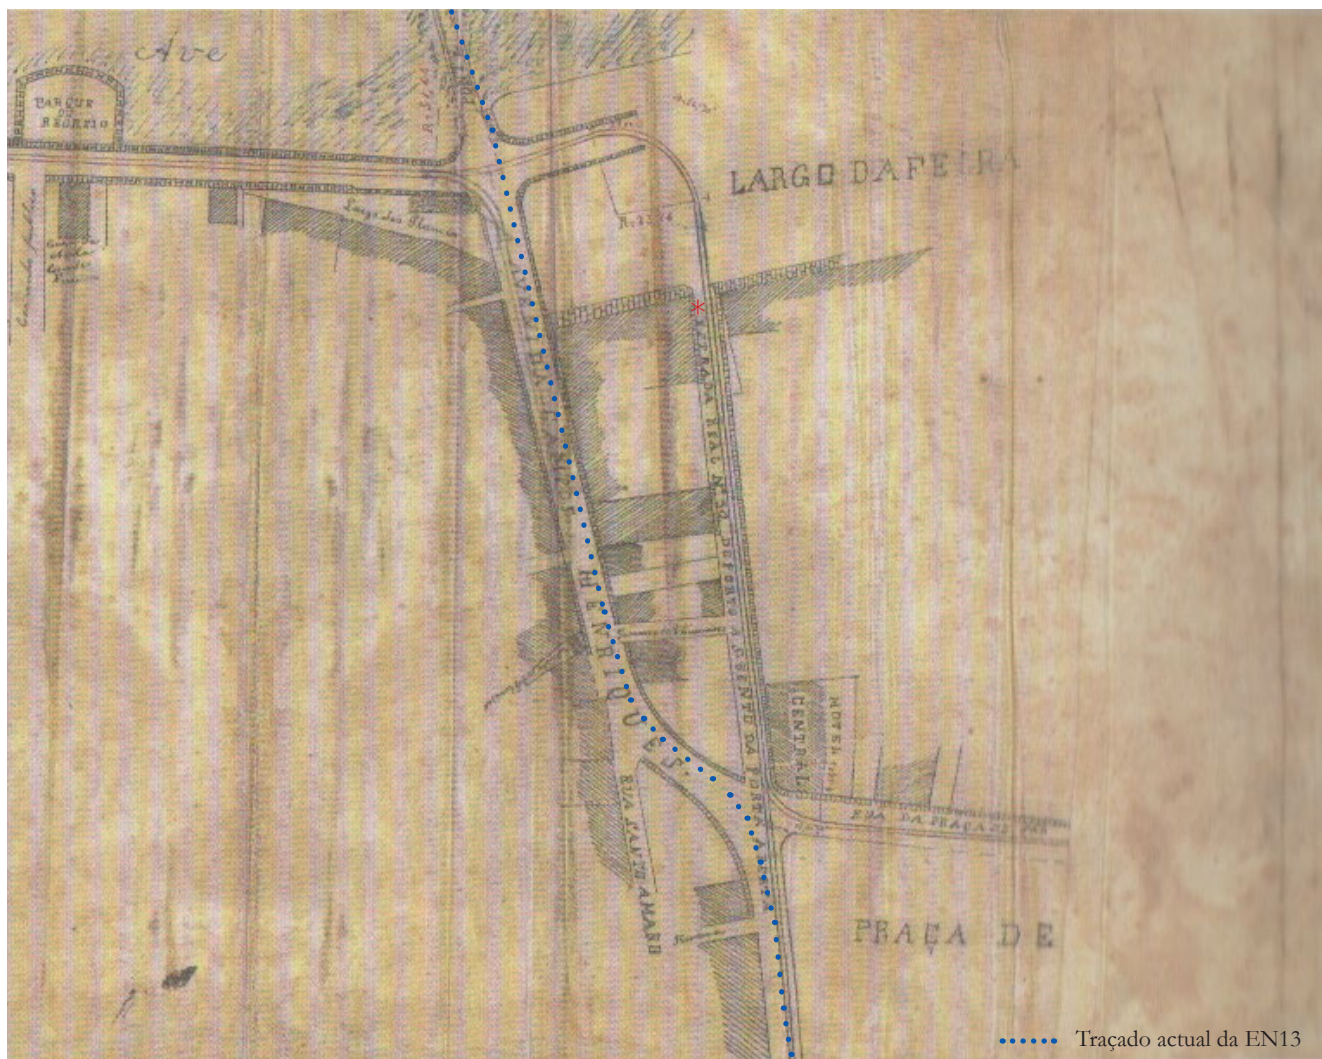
| Planta da linha do carro eléctrico. Traçado do primeiro segmento a ser construído em Vila do Conde da Estrada Real nº30. 1899.
